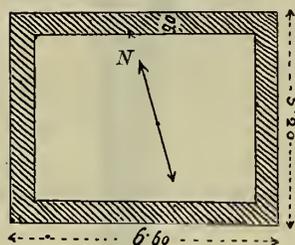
Grundriss eines römischen Gebäudes.
